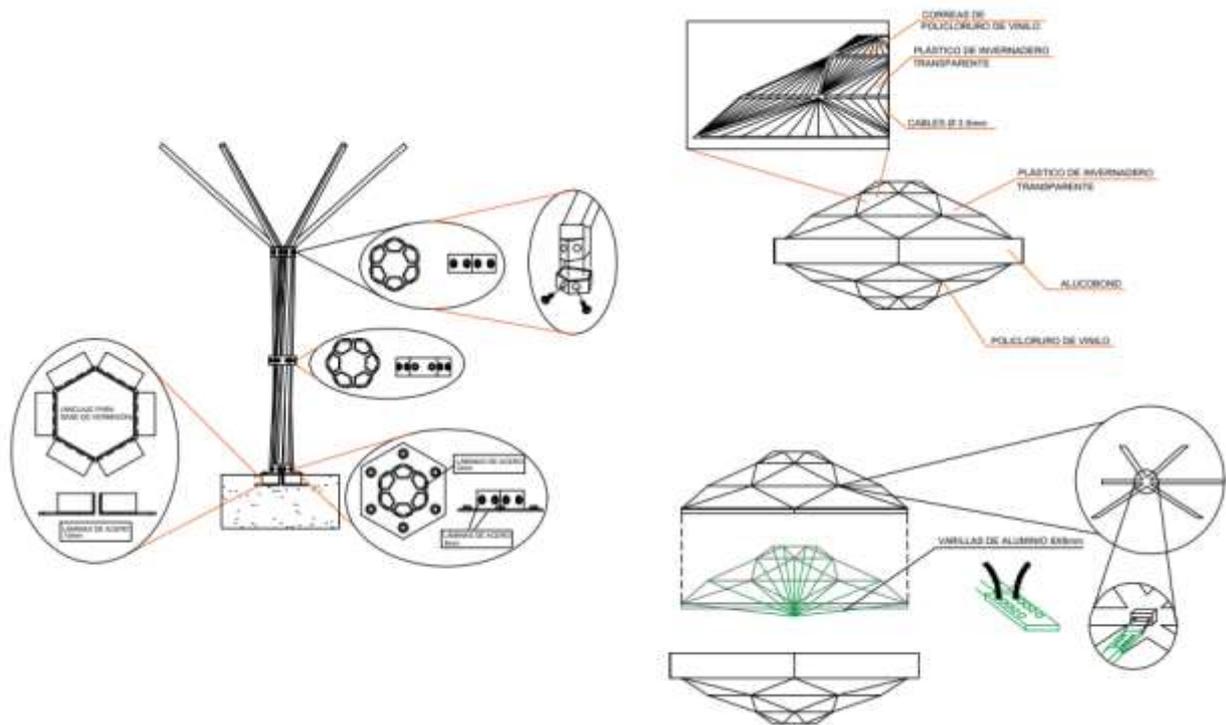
Detalles constructivos del elemento modular en cubierta biomimética
